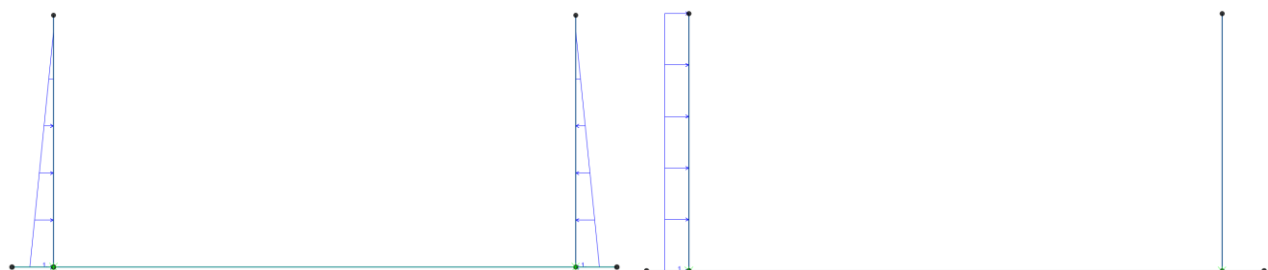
Peso permanente portato del terreno di ricoprimenti: sotto la pavimentazione stradale 15.2 kN/m/m, sull'esterno della ciabatta di fondazione 60.8 kN/m/m.
